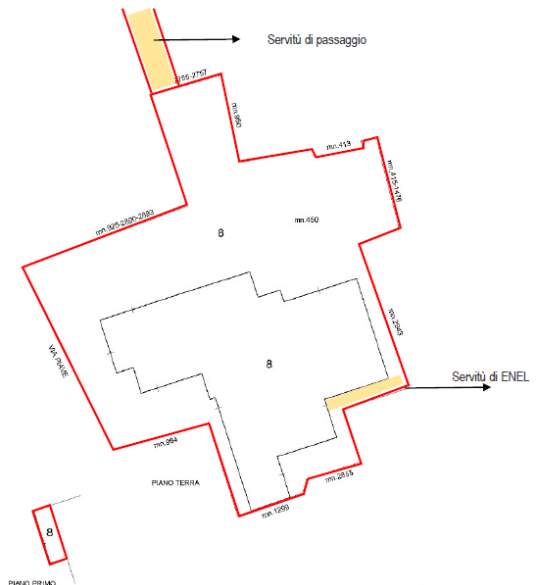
Elaborato planimetrico aggiornato post Fase 0
